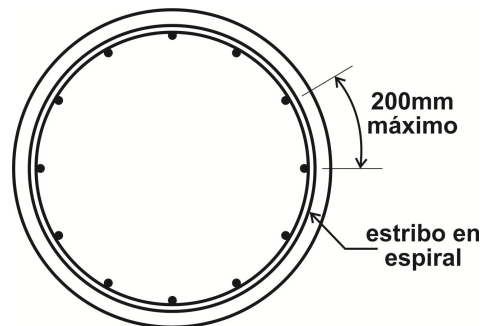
1: Columna con armadura transversal de espiral simple
